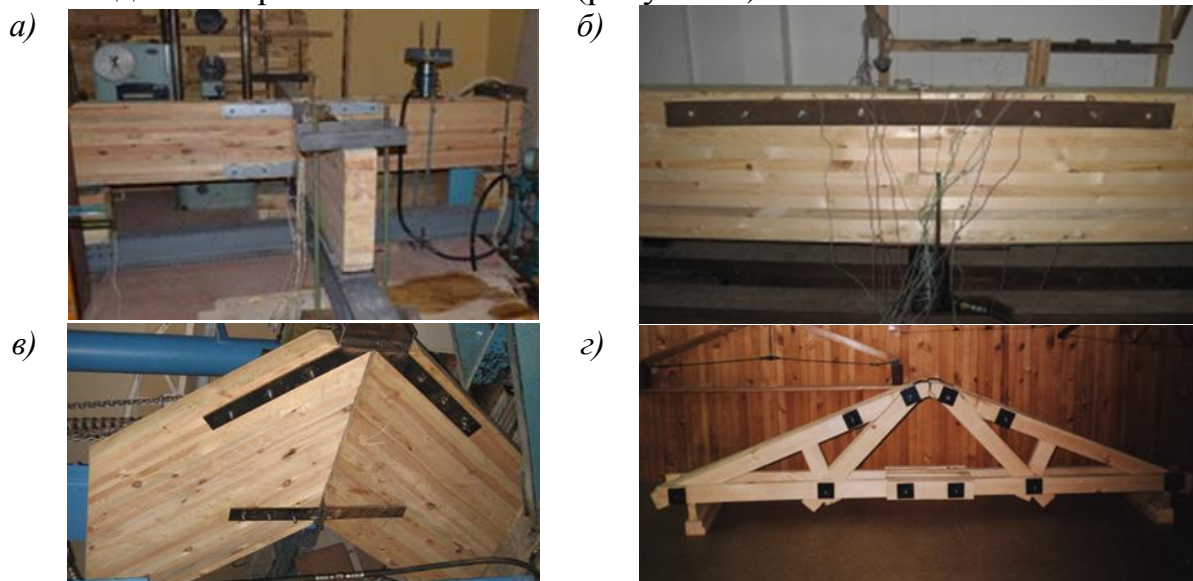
Соединения деревянных конструкций на вклеенных шайбах: а) жесткий узел балочной структуры; б) стыковое соединения балок; в) коньковый узел рамы; г) двухскатная ферма
